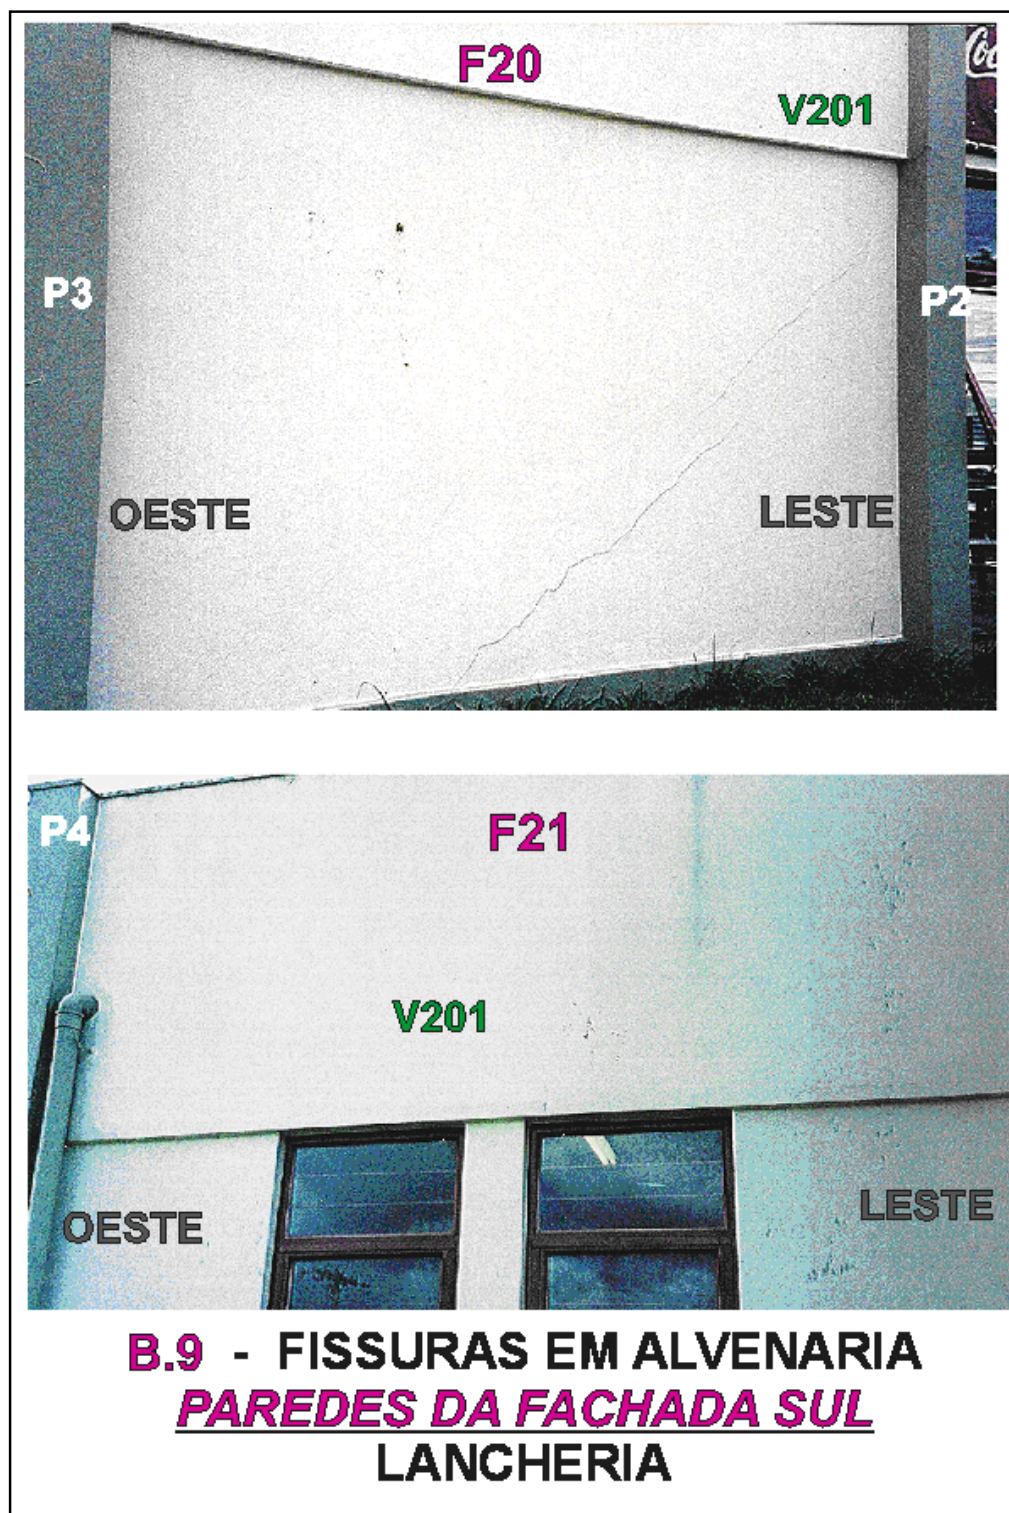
Fotos de fissuras manifestando-se em paredes externas de alvenaria na fachada sul (ISAIA, 2001, p. 52)
